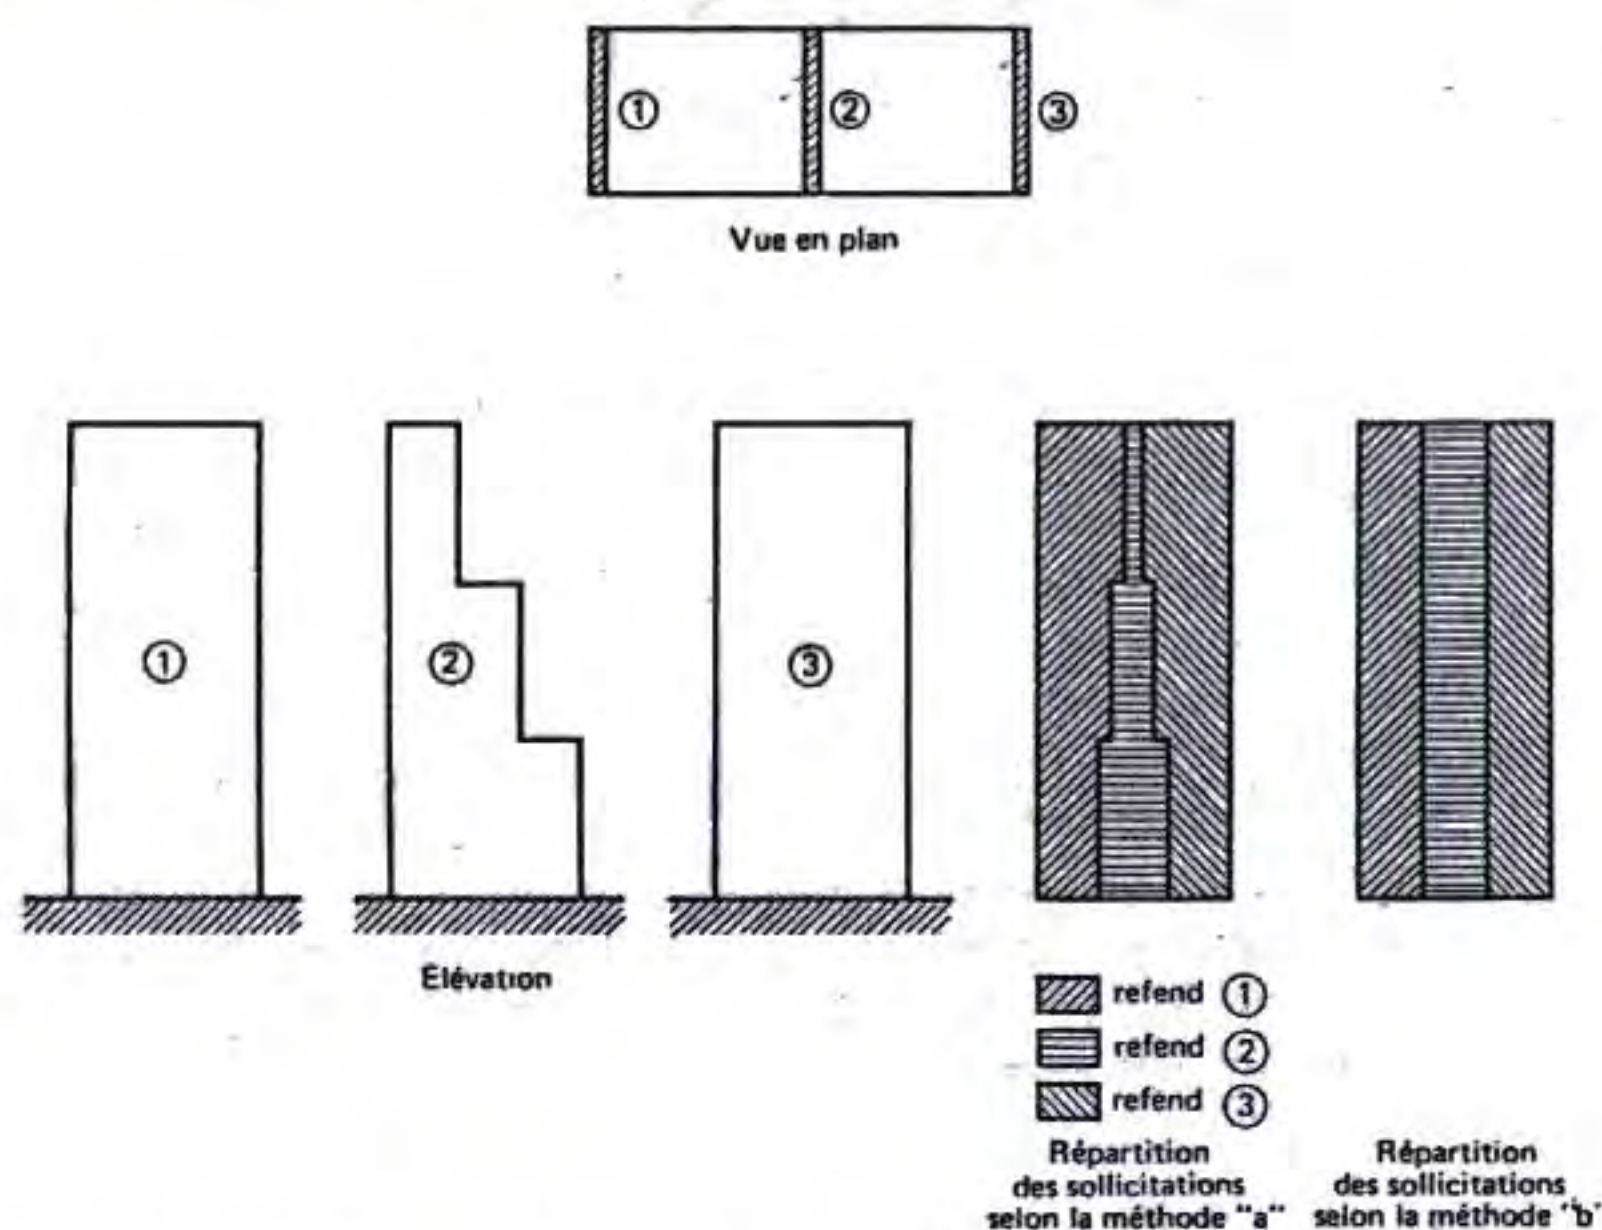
Changement de section des refends sur la hauteur de l'ouvrage.
